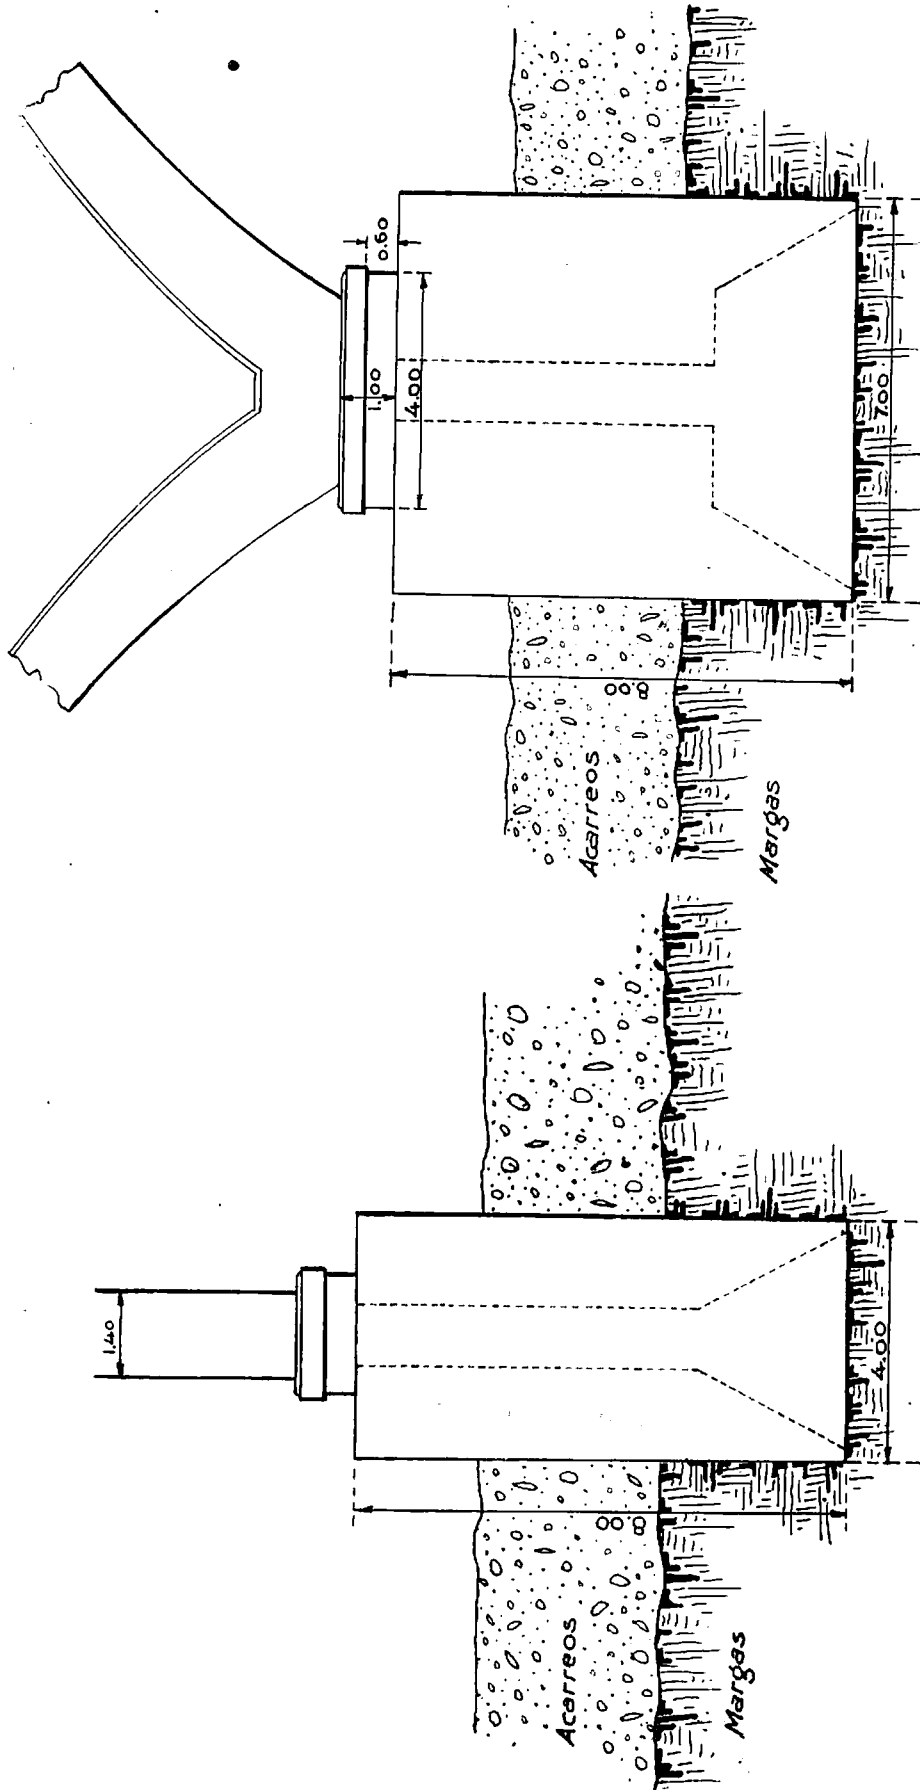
ª — Cimentación de una pila de apoyo de los tableros.
